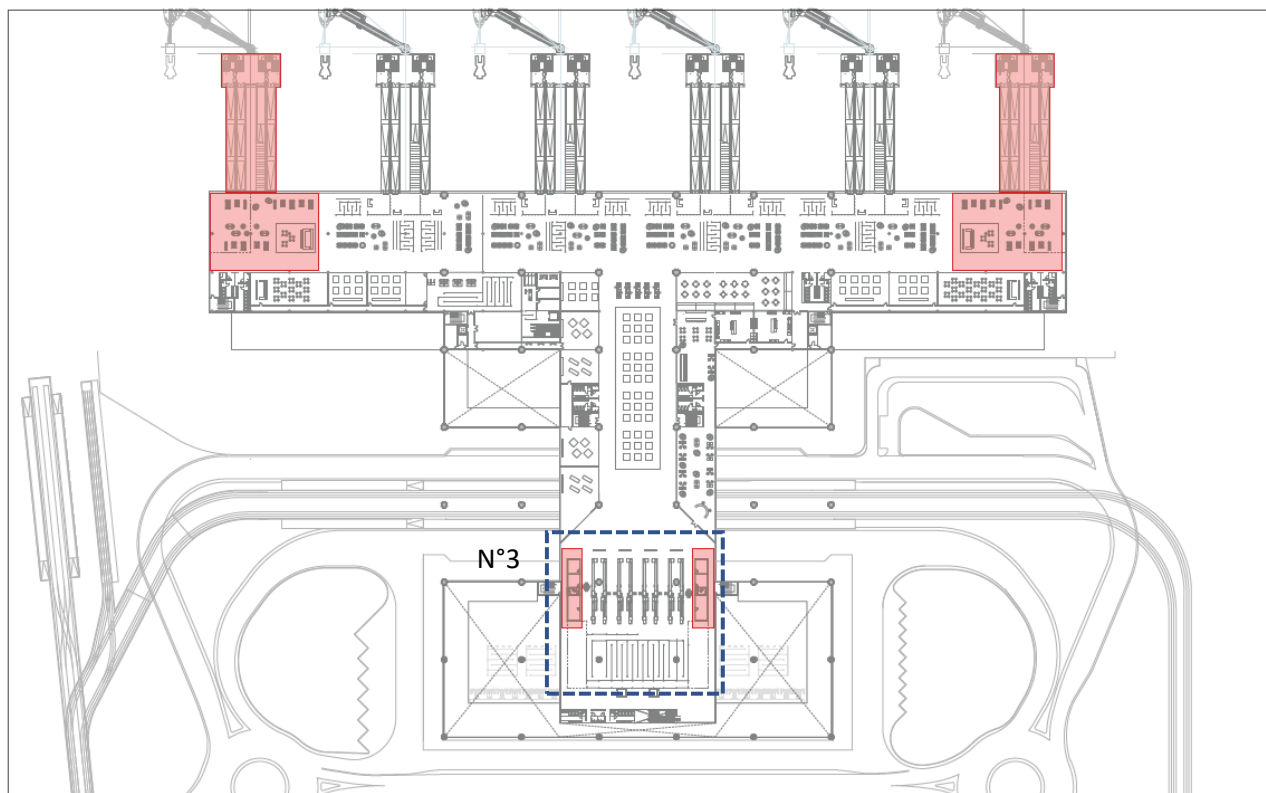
| Planimetria del Primo Piano 2026 - Area di flessibilità operativa
